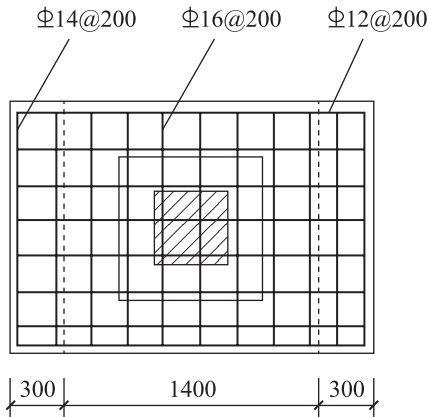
矩形独立基础底板底部的短向钢筋示意图
